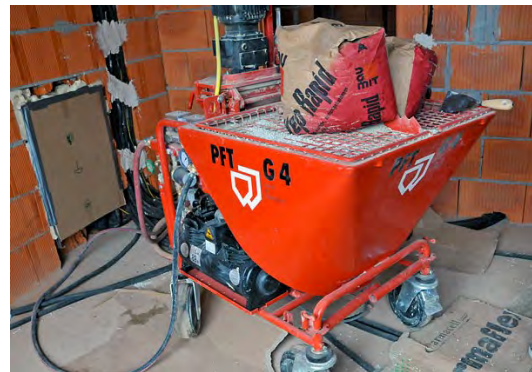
Makina për përgatitjen e betonit të lehtë
